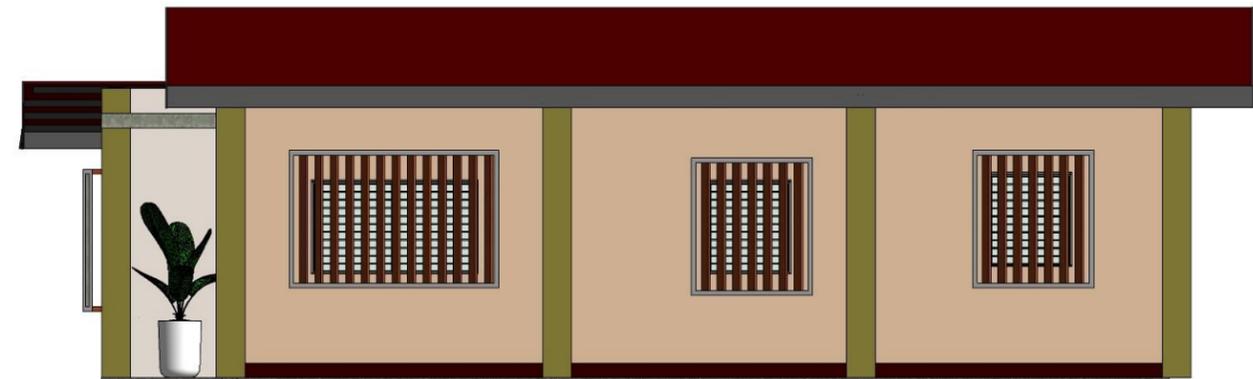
Fachada Noroeste de vivienda H-4. Fuente: Propia.
